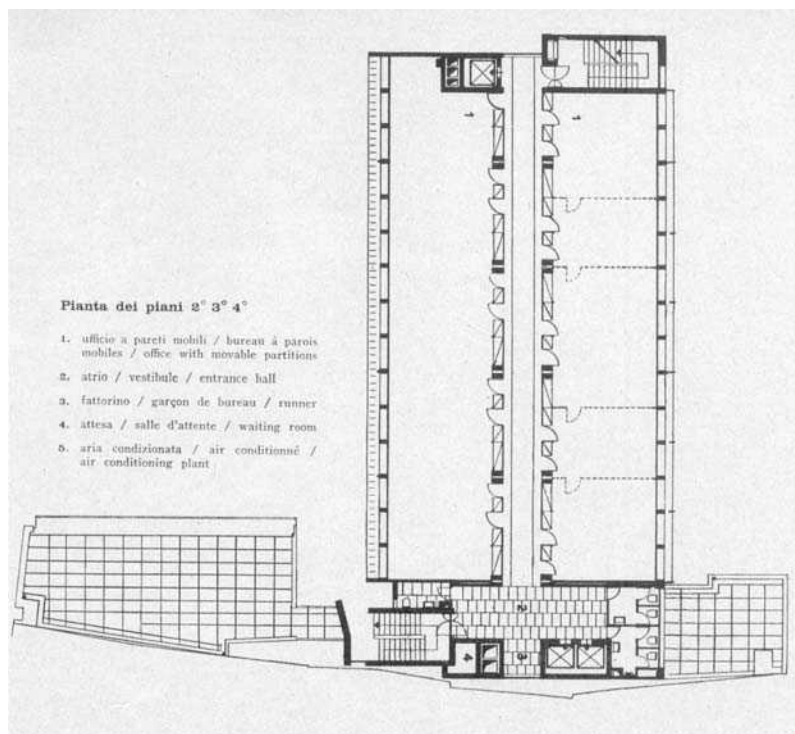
Planta do 2º., 3º. e 4º. pavimentos
